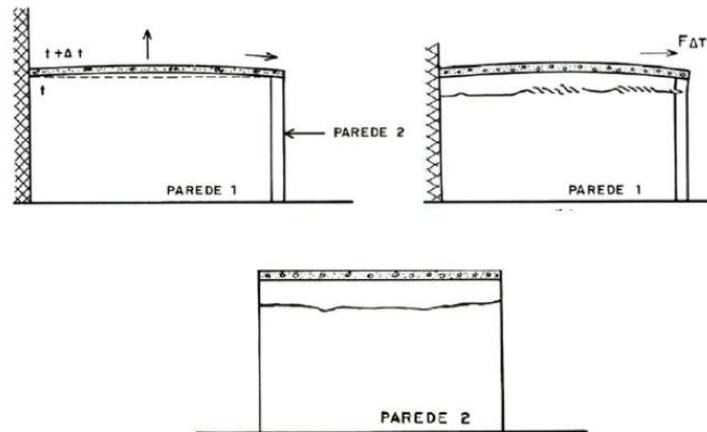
Fissuras provocadas pela movimentação térmica da laje de cobertura.
